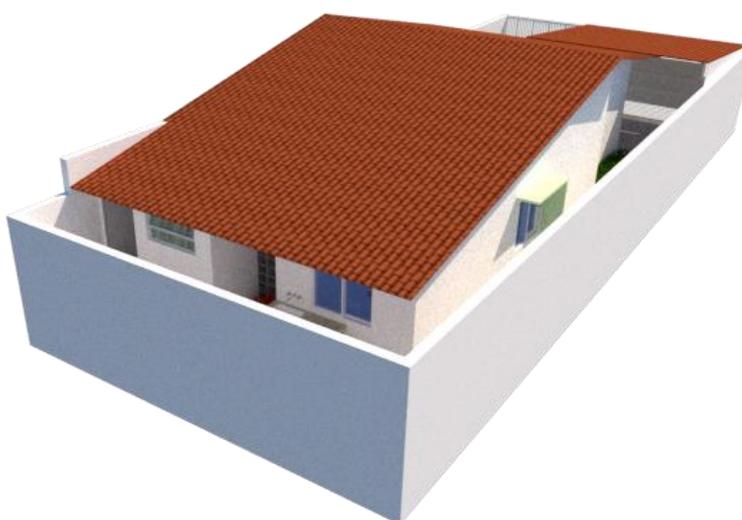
Proposta espelhada orientada à Sudoeste - Fachada lateral
